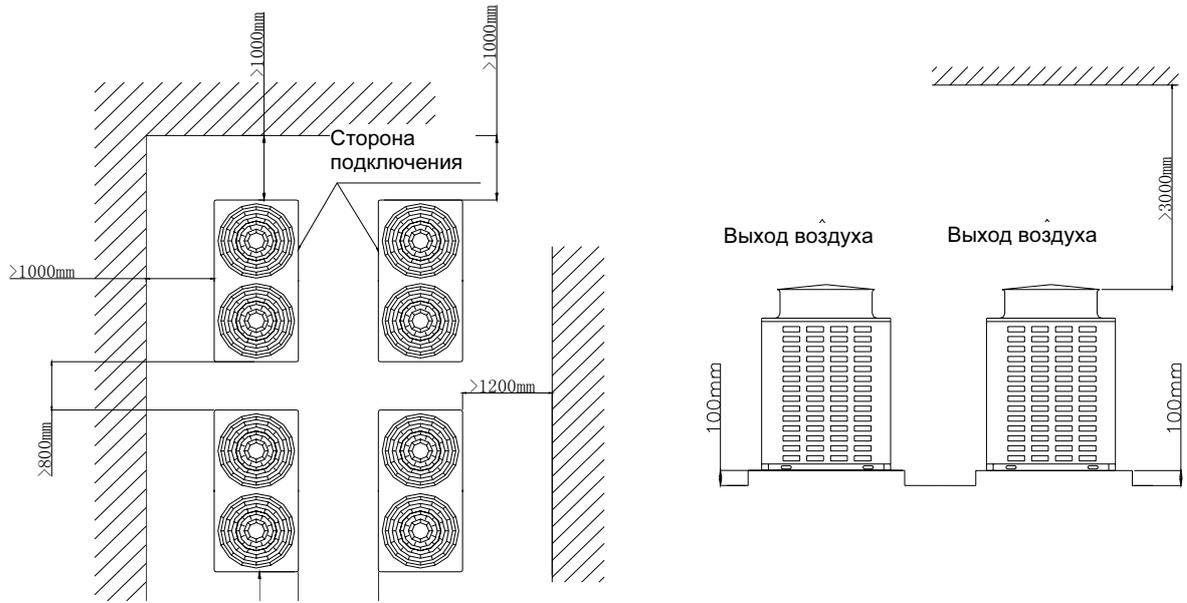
Требования по размещению группы наружных блоков с выпуском воздуха сверху
